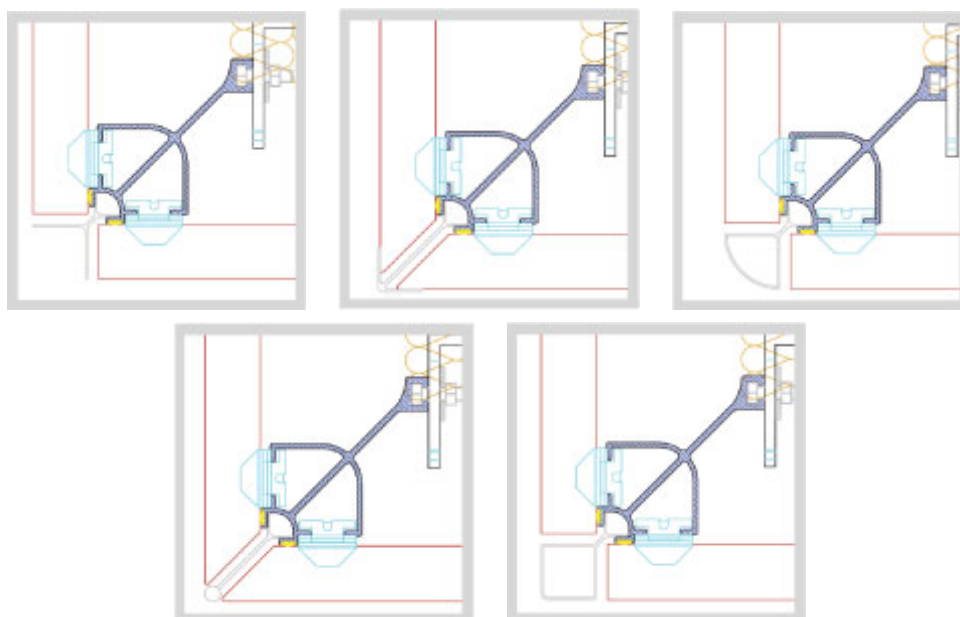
Aplicação da fachada ventilada – Canto com perfil de alumínio – várias soluções [47]
